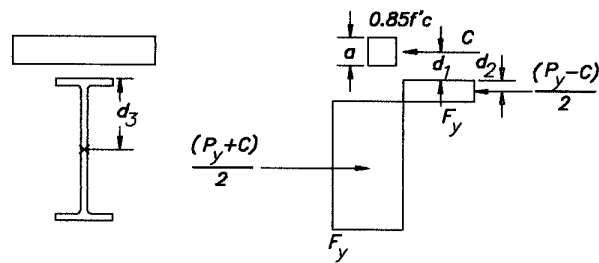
Distribución plástica para momento positivo en vigas de sección mixta
